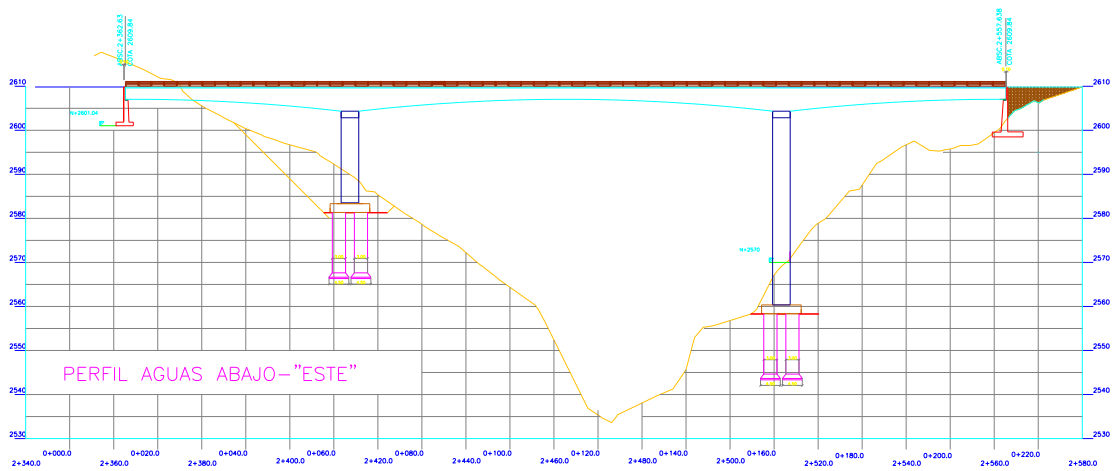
Geometría final del puente de hormigón pretensado en volados sucesivos.
